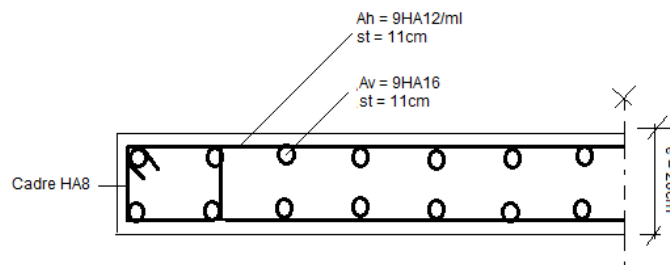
Coupe longitudinale du schéma du ferrailage des voiles.
